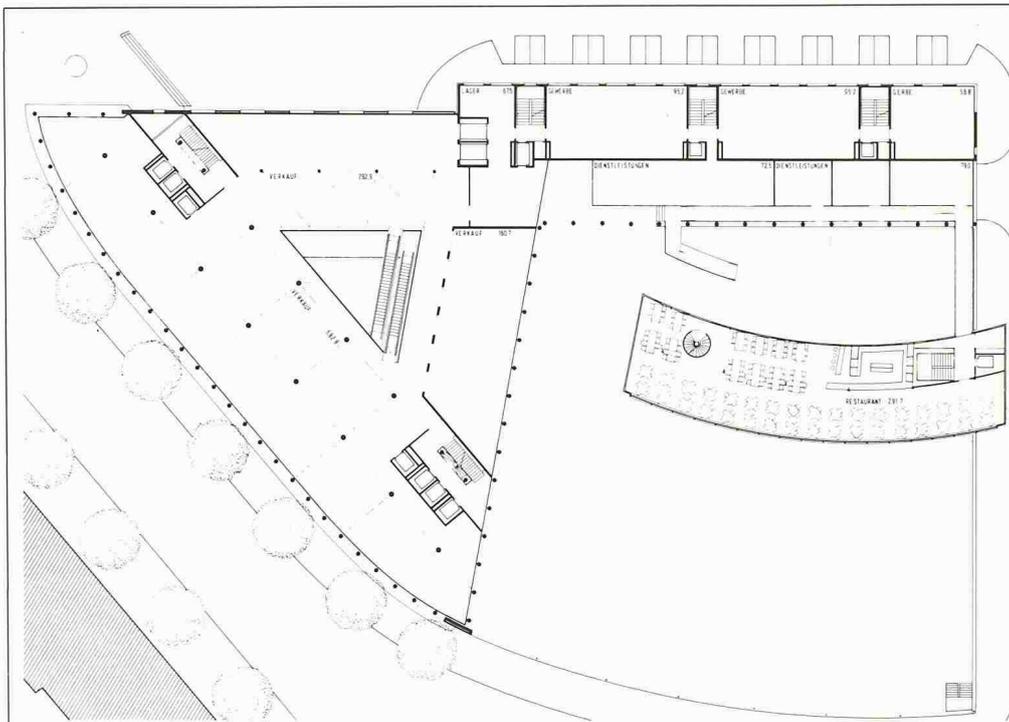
1. Obergeschoss. Eine Rampe führt entlang der gedeckten offenen Halle ins Restaurant
